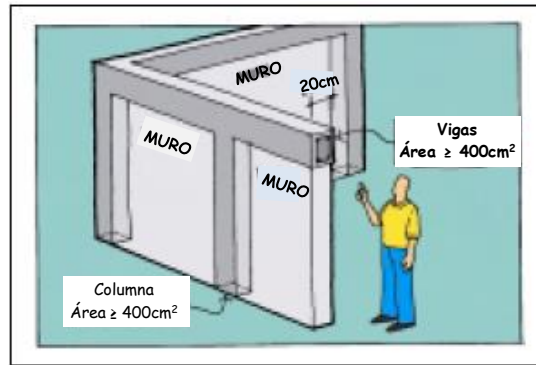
Detalles de columnas y vigas de confinamiento - Chavarría (2001)
